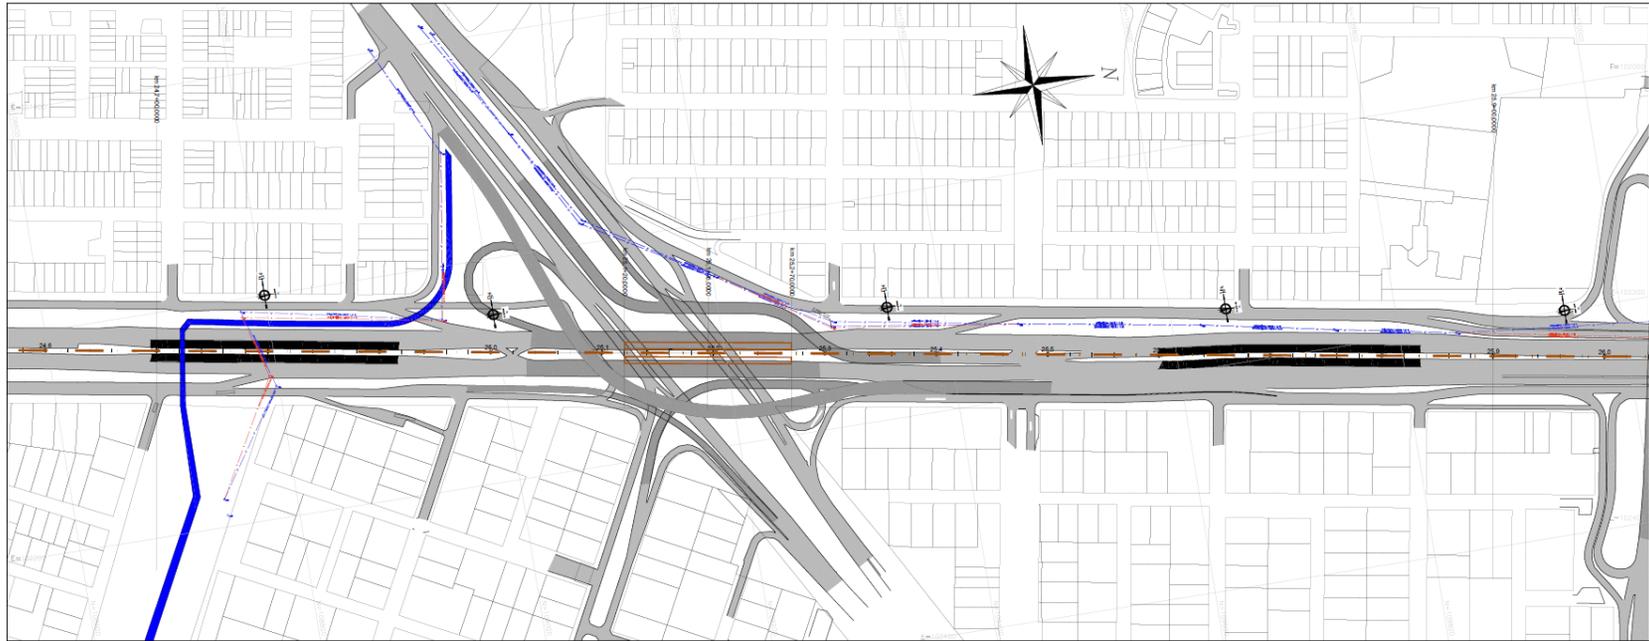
Vista en planta Alternativa 2, Tramo calle 72-calle 90
